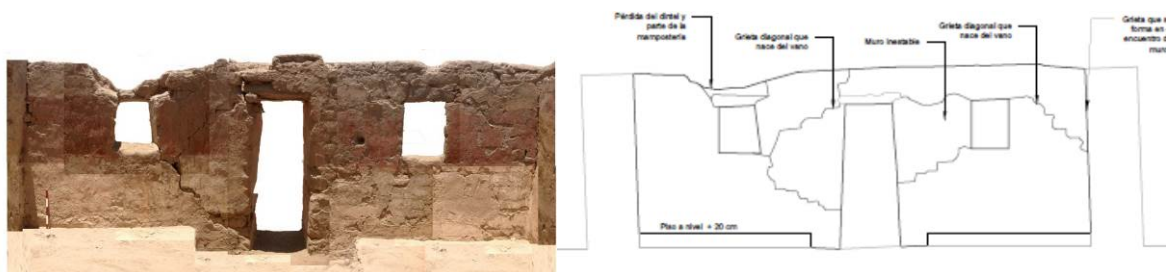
Plano de grietas del Recinto 62 en Tambo Colorado
